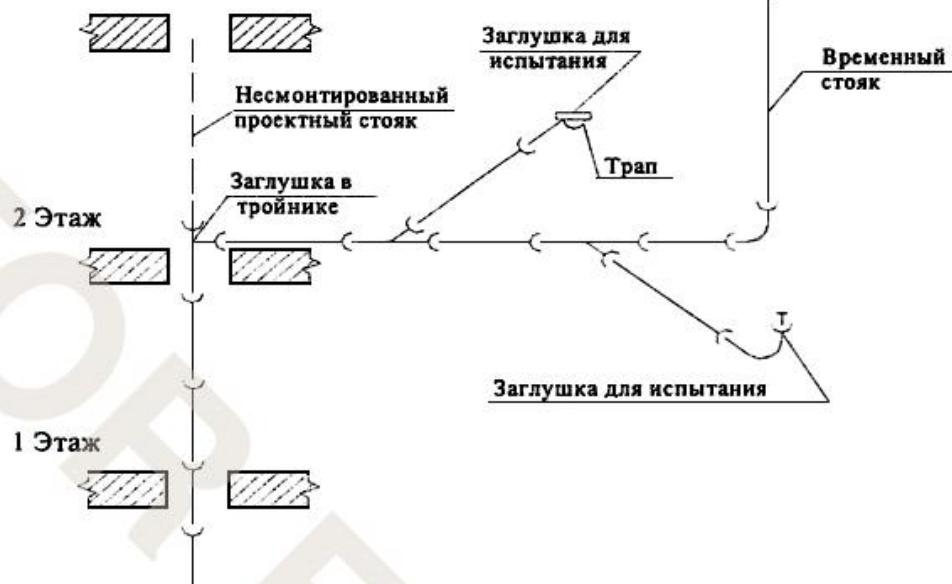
Схема гидростатического испытания отводных трубопроводов, проложенных в конструкциях междуэтажных перекрытий
